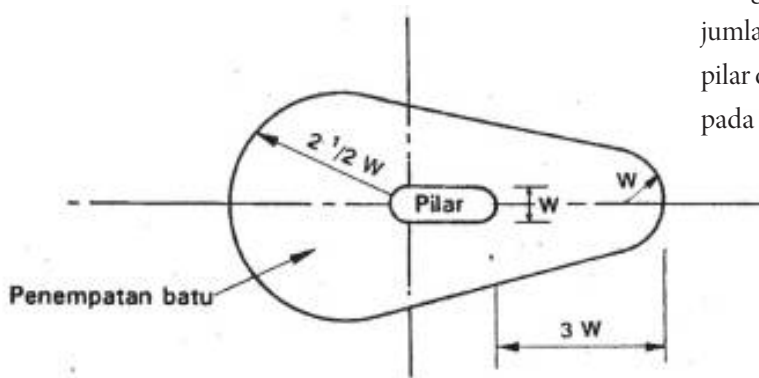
Perlindungan Fundasi Pilar
